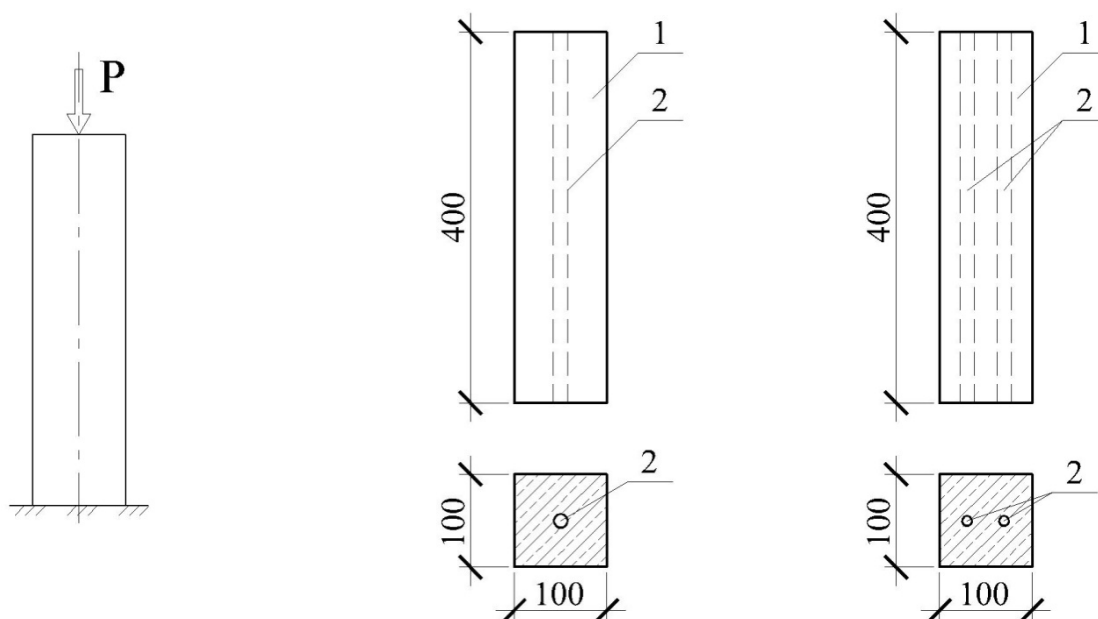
Схема випробувань (а) і конструкція дослідних зразків при розміщенні одного (б) і двох (в) стержнів арматури у поперечному перерізі; 1 – бетонна призма; 2 – стержень (стержні) композитної арматури
